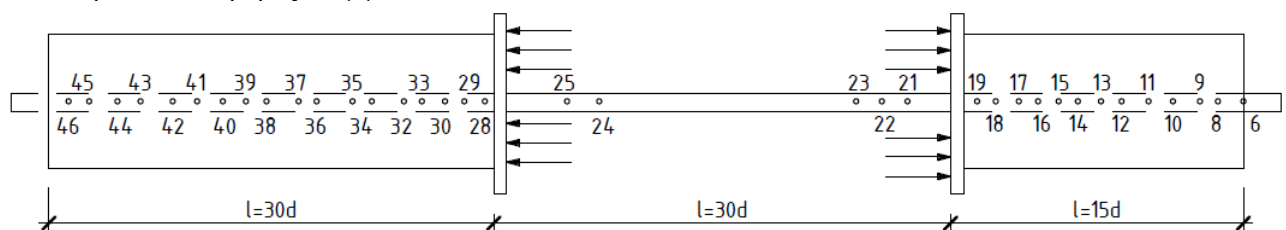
Испытательная схема ранее выполненных исследований [24]. 6-46 – датчики деформаций, расположенные на арматурном стержне и в бетоне, d – диаметр арматурного стержня.
